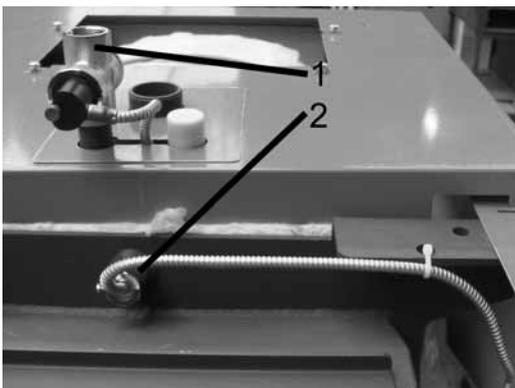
Thermische Ablaufsicherung, Montage im Kessel
